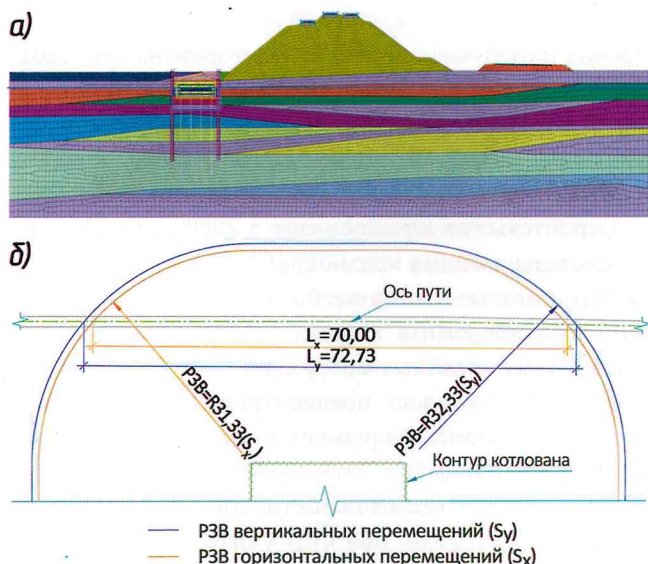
Расчетная схема с развитым в плане котлованом (а) и план расчетных зон влияния (РЗВ) (б):
